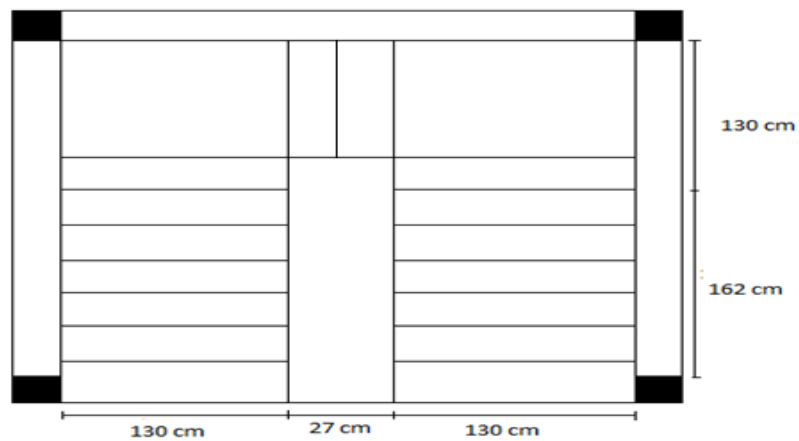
Vue en plan d'un escalier droite à deux volées.
